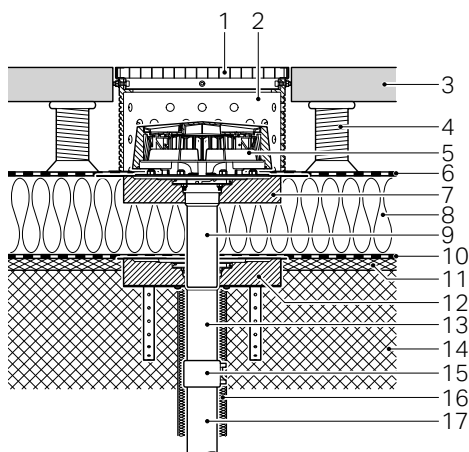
Aufbau Massivdach gedämmt, mit Dampfsperre und Dachabdichtungsfolie, befahrbar
